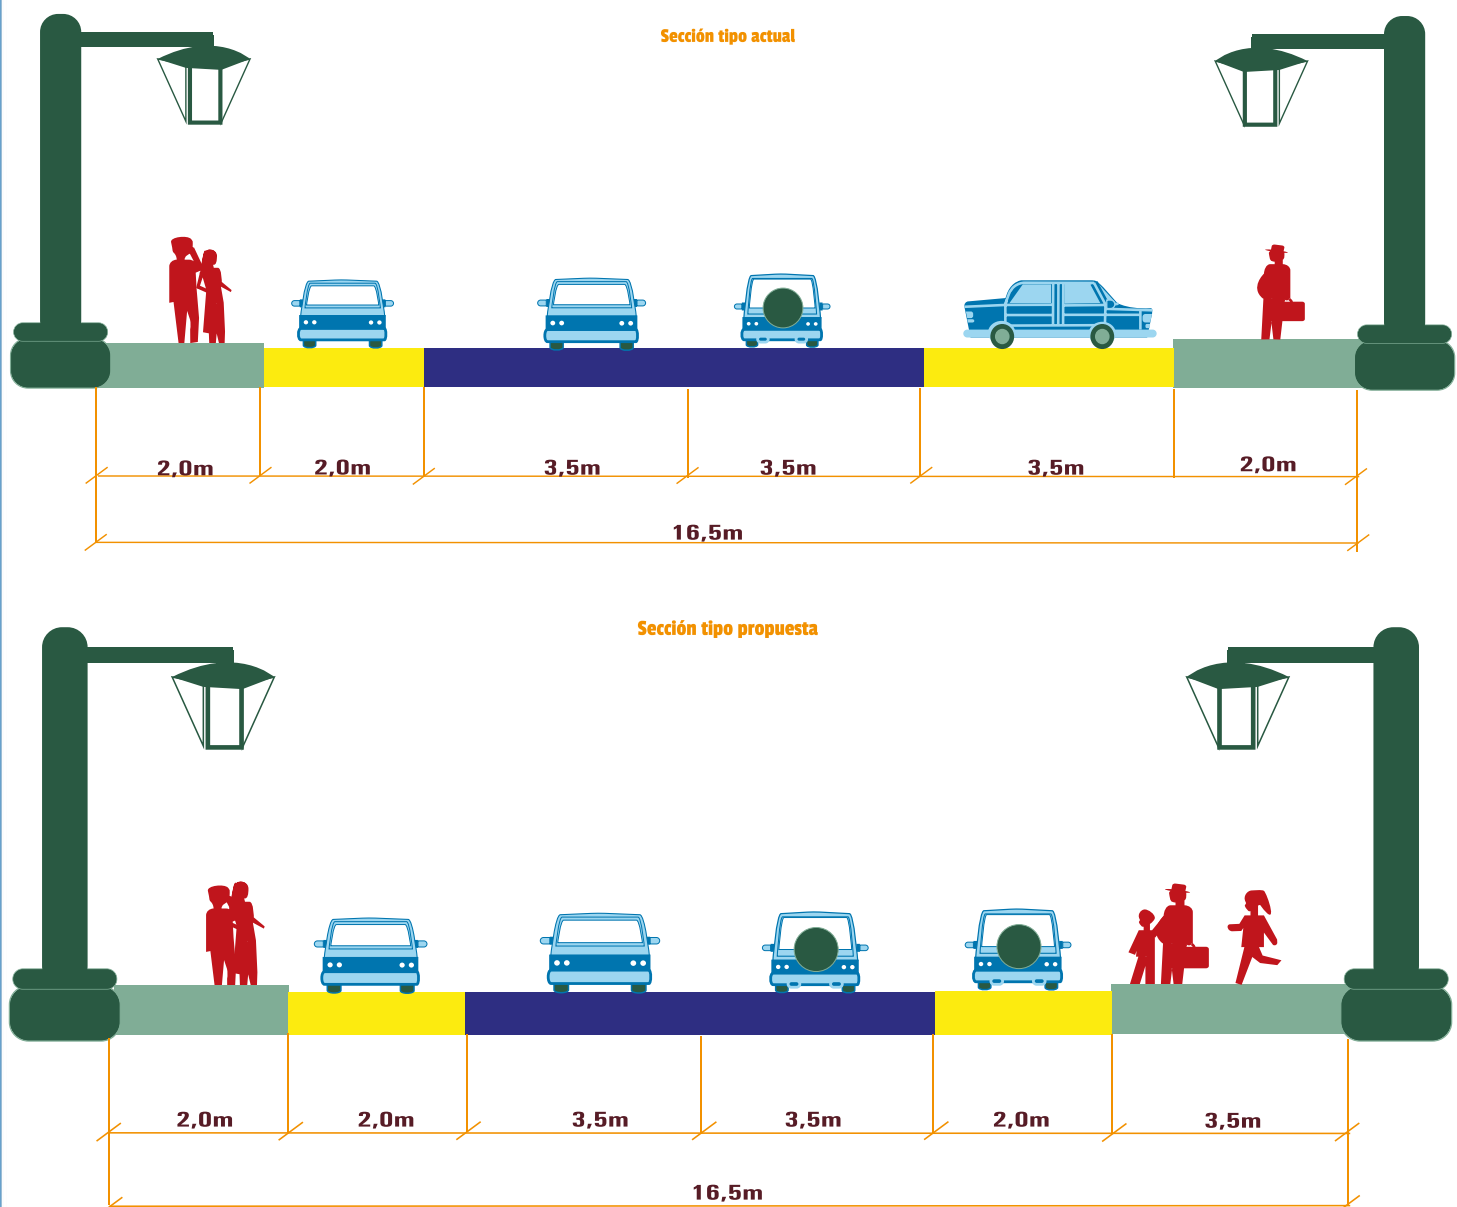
Ejemplo de reordenación del aparcamiento en calles con aceras estrecha. Sección tipo actual y sección tipo propuesta
